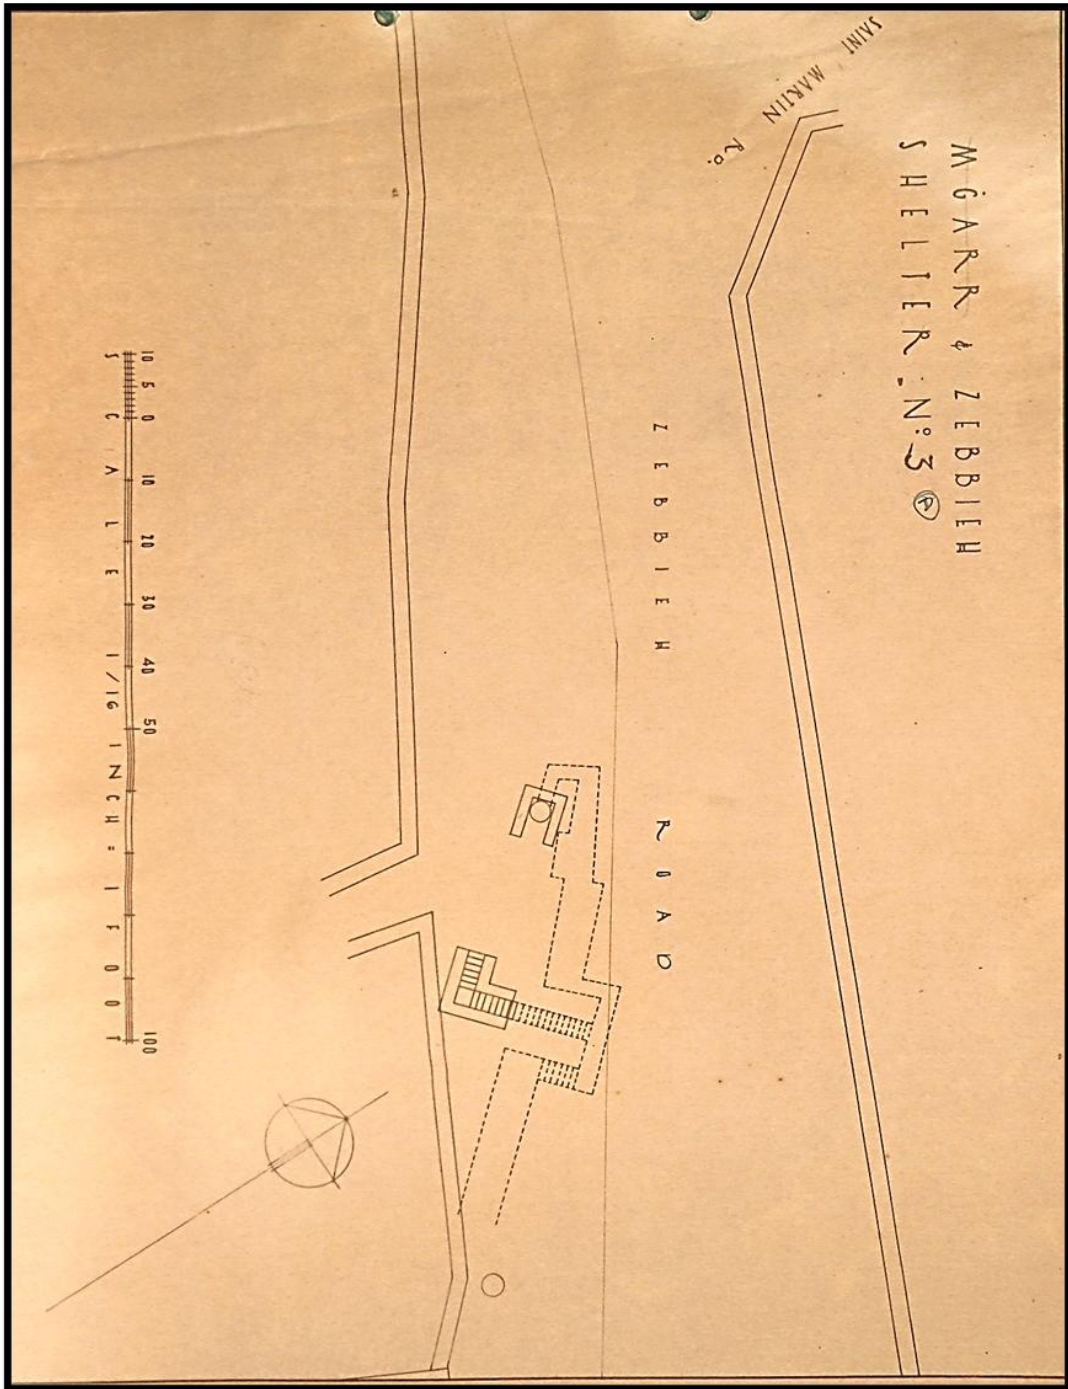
Planta do Abrigo nº3ª "Zebbieh Road – Saint Martin Road."
